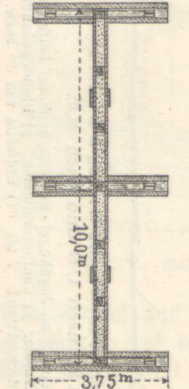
Grundriss und Querschnitt der Coulissen.
